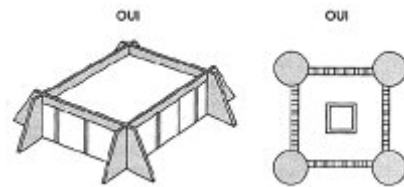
Fondations en étages enterrés formant caisson cloisonné rigide (M. Zacek, 1996).
